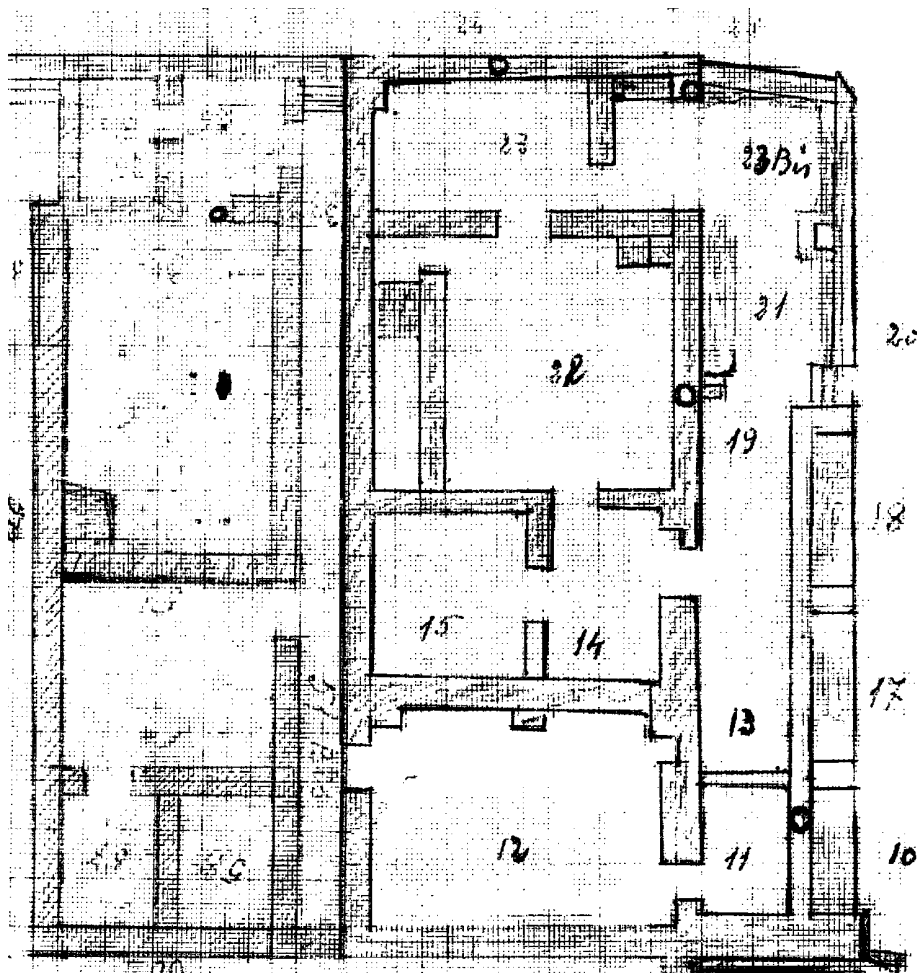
Velia. Quartiere meridionale. Unità I.2. Stralcio da una pianta di archivio.
